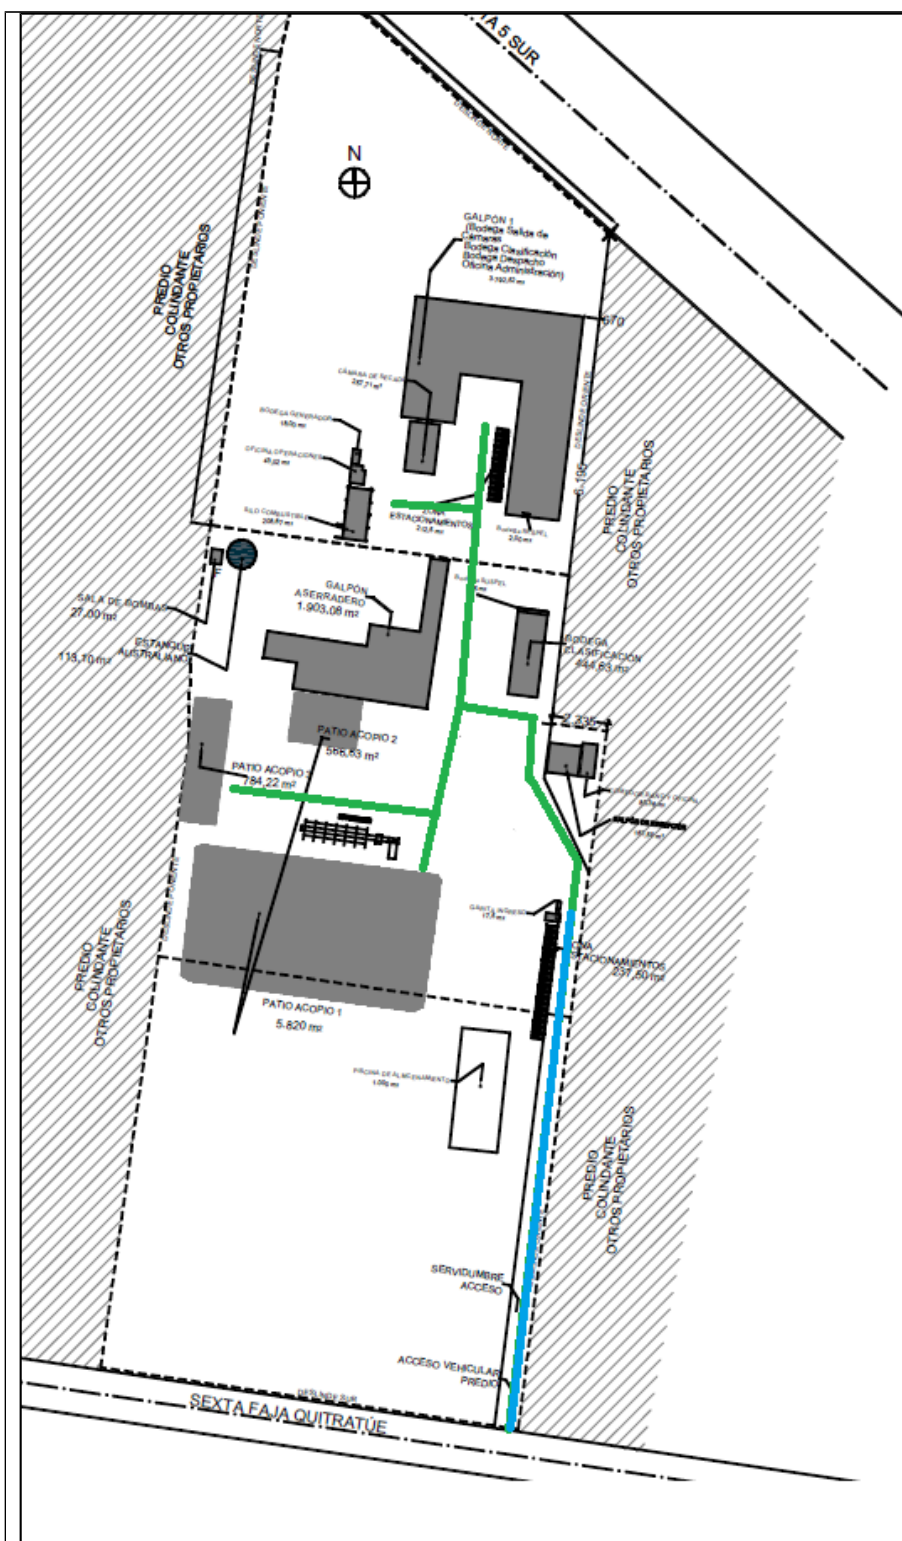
de la Adenda 1. Figura esquemática Layout Planta (línea verde: zona de tránsito pavimentado, línea azul camino de acceso ripio).
